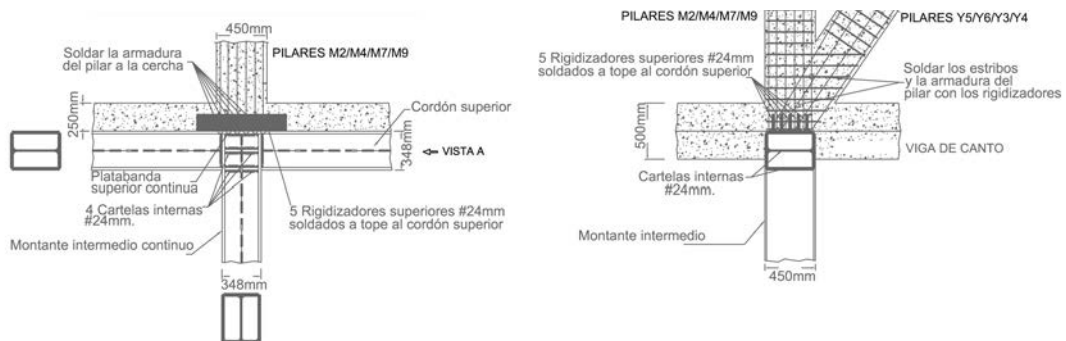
Detalle de pilar inclinado naciendo del cordón superior de la cercha
